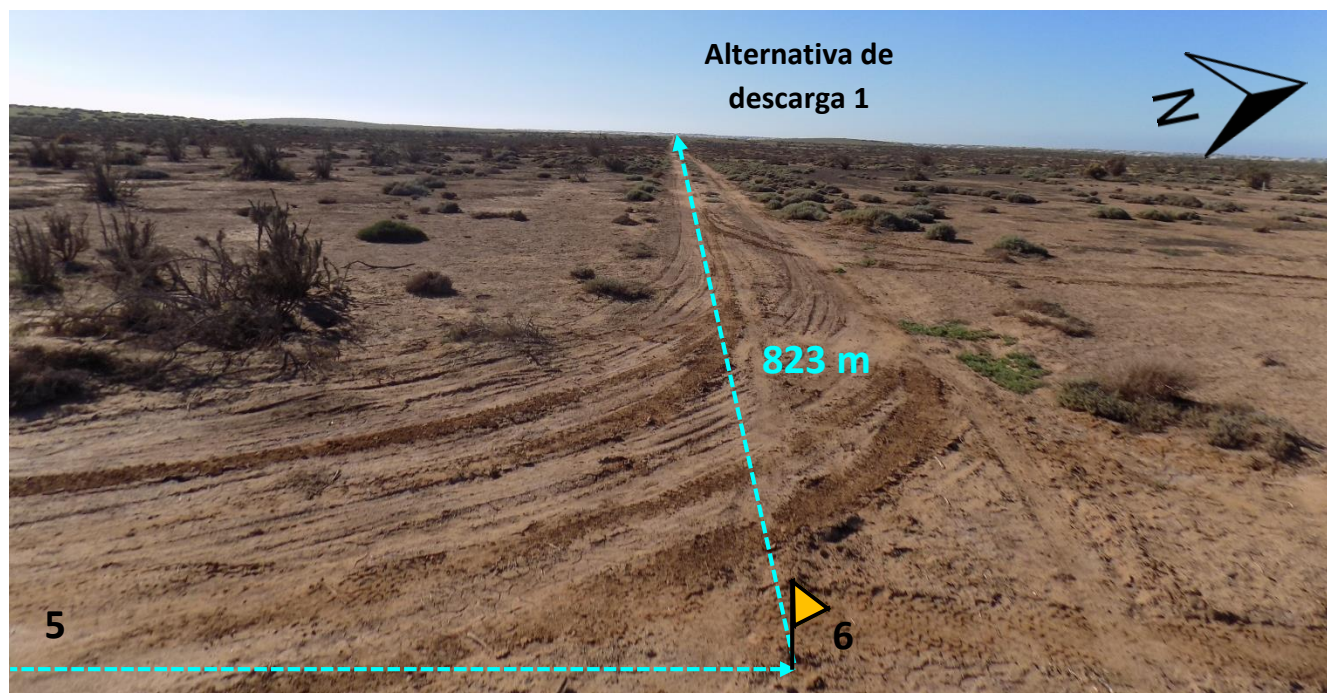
Sexto y último tramo de tubería entre el vértice 6 y el punto de descarga.
